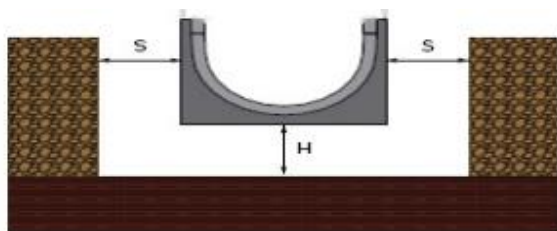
Vgradnja LTŽ rešetke na betonski jašek.
